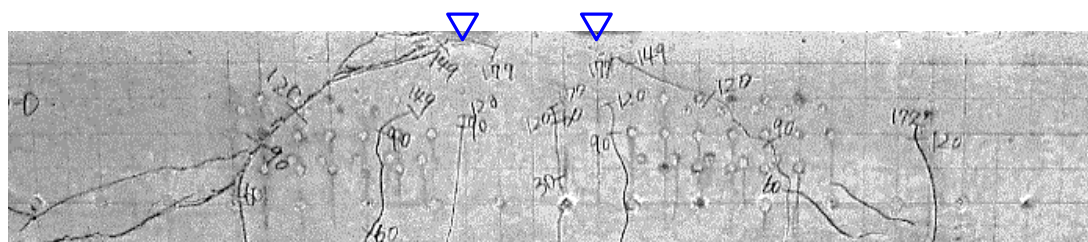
収縮 Ps1.5%-250D ひび割れ状況（せん断圧縮破壊例）
